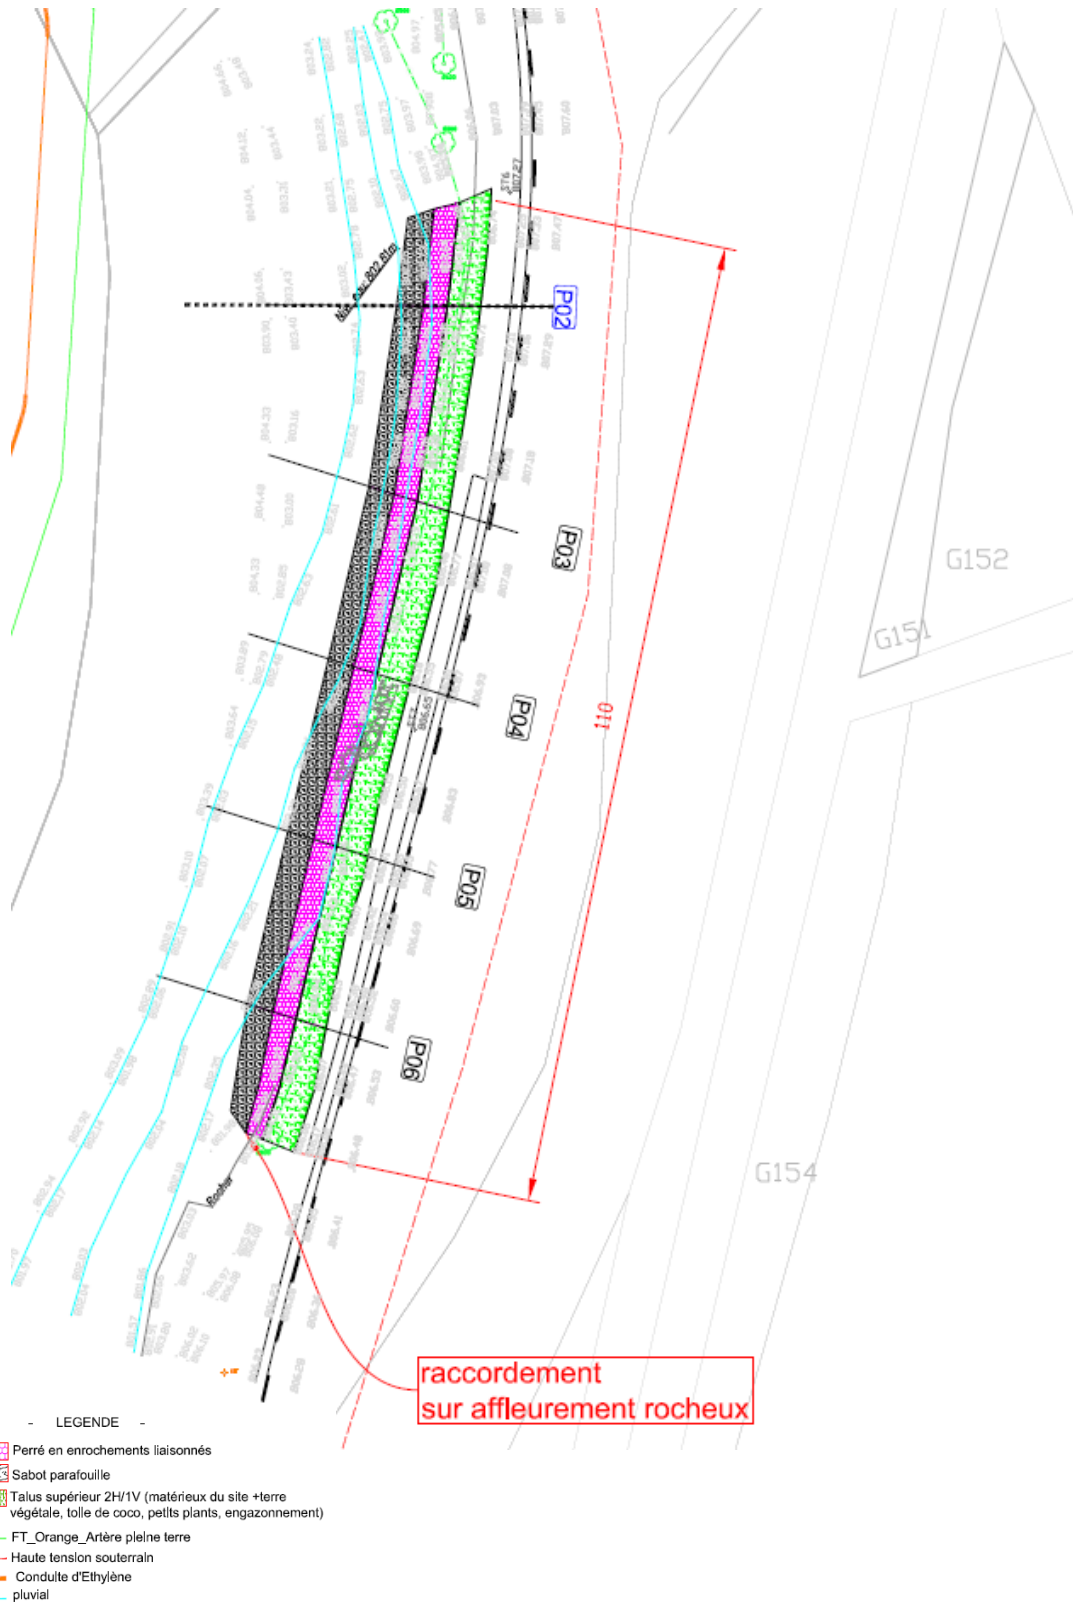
Site 10 : vue en plan et coupe de confortement à P02
